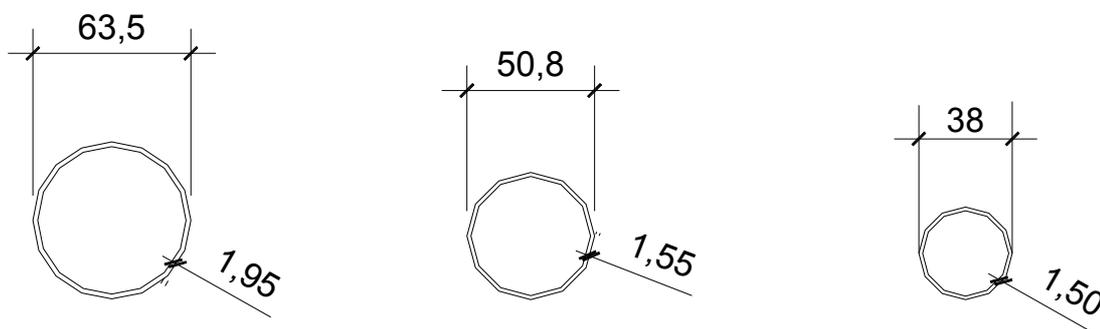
Cerca tipo 7 detalhe dos postes metálicos
